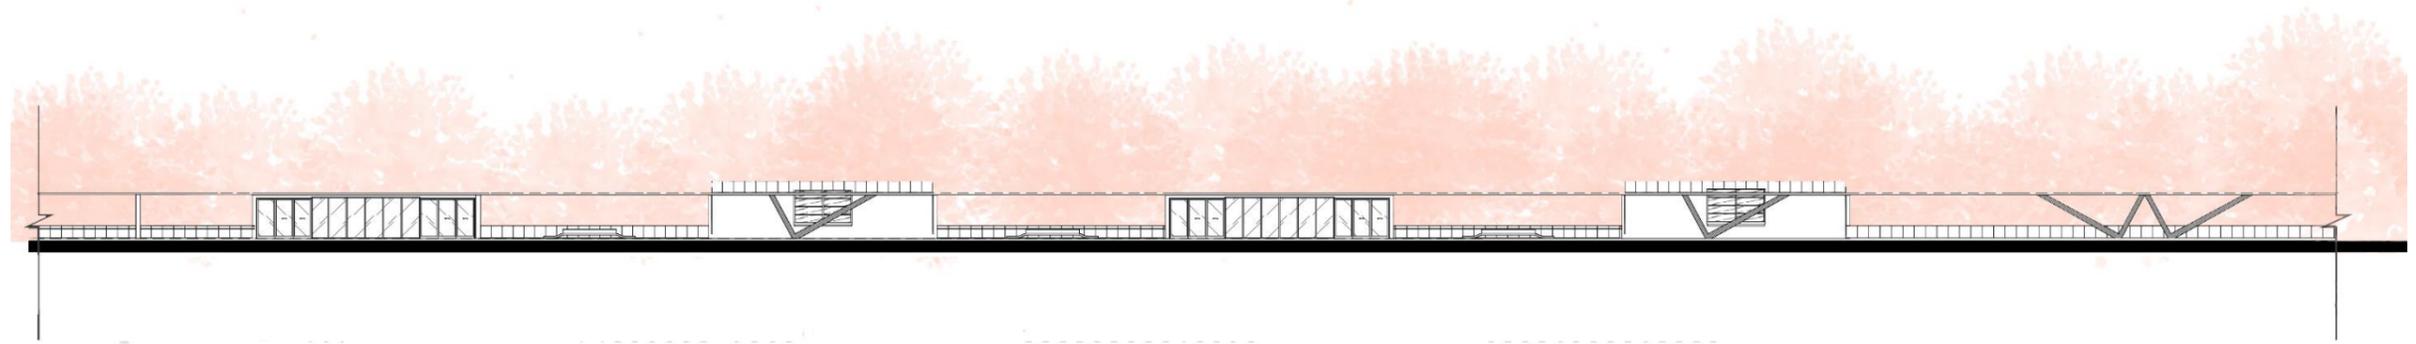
Fachada 02 – NORDESTE Vista do Parque
